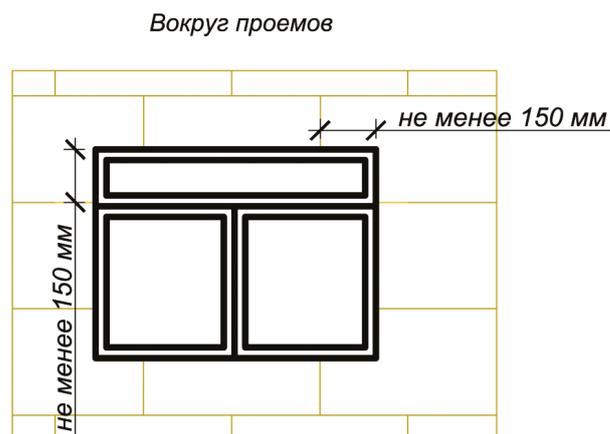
Схема монтажа теплоизоляционных плит вокруг проемов
